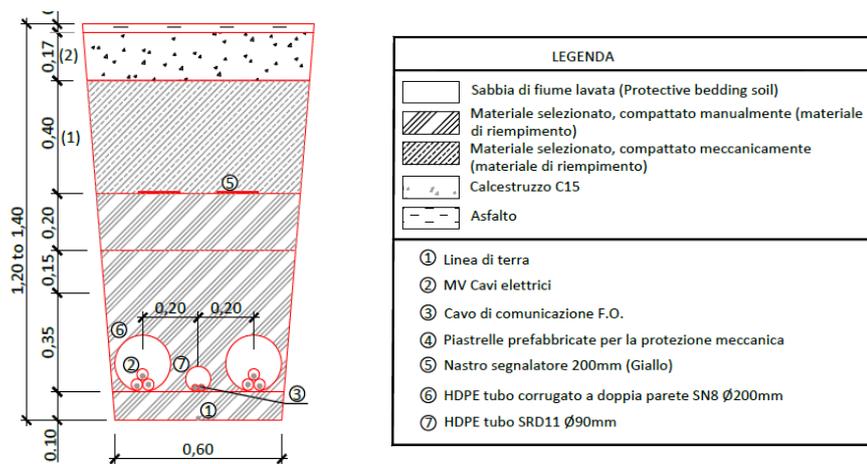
Sezione tipo cavidotto su viabilità pubblica
